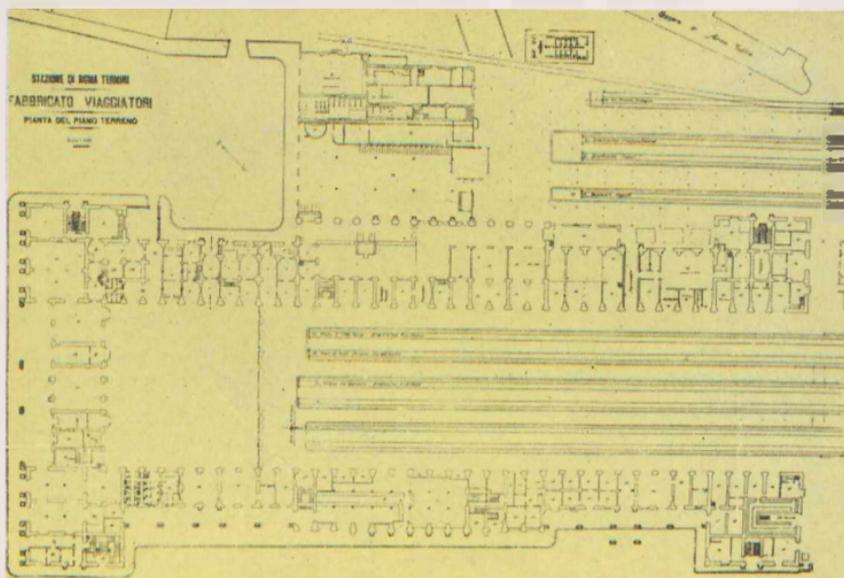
Pianta del F. V. di Roma Termini - Progetto dell'ing. Bianchi.
